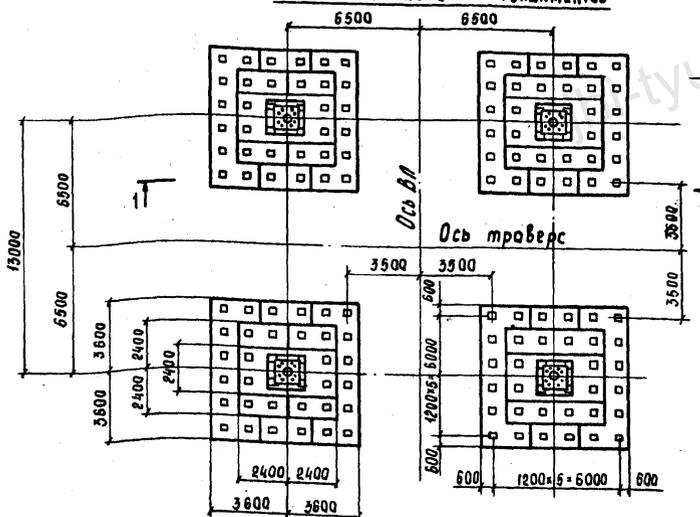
Отдельные блоки под каждую ногу опоры. Вариант фундамента со сборными плитами в основании.
